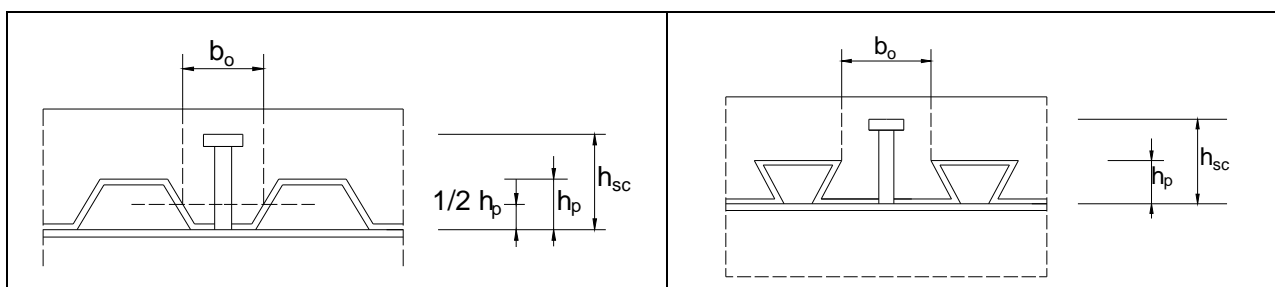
(b) *Disposizione della lamiera grecata rispetto al profilo in acciaio.
